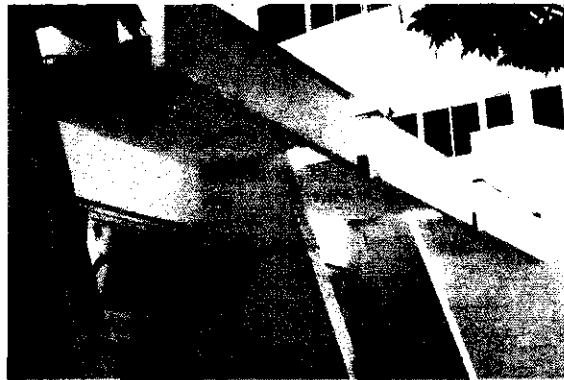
, Grietas en muros del edificio-comedor.
